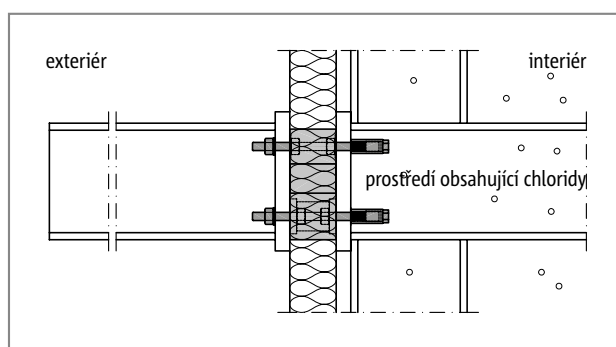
Schöck Isokorb® T typ S-N a T typ S-V: Napojení ocelové konstrukce na železobeton
